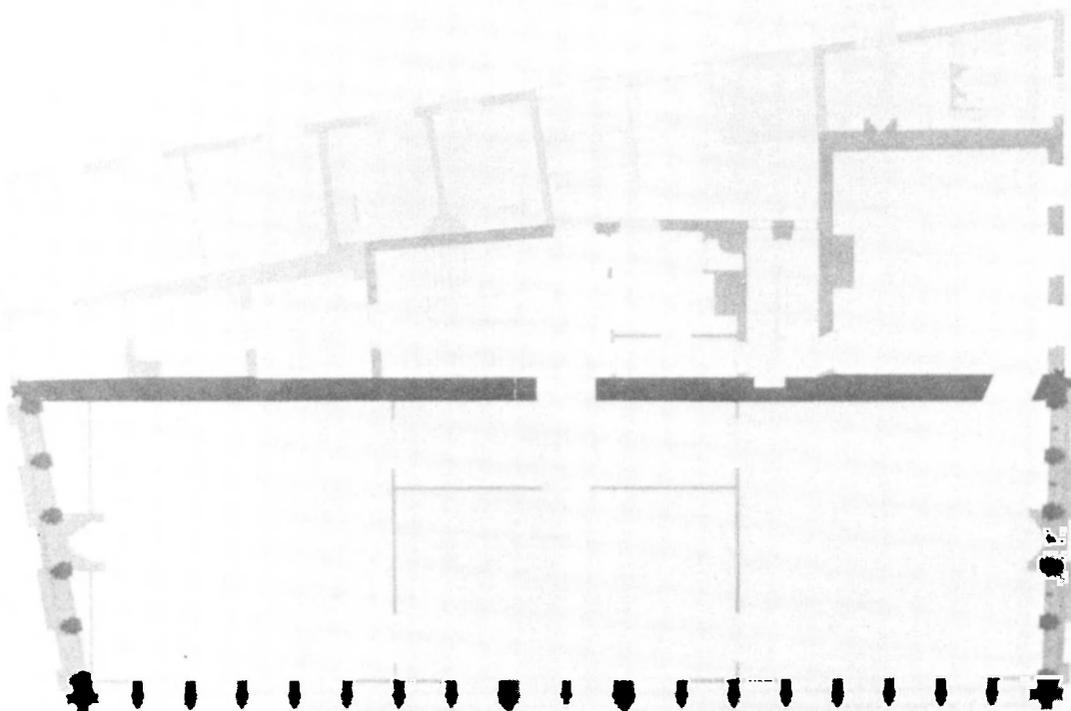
M.d.R., plan du premier étage, état ancien, 1875, A.A.V.B.
